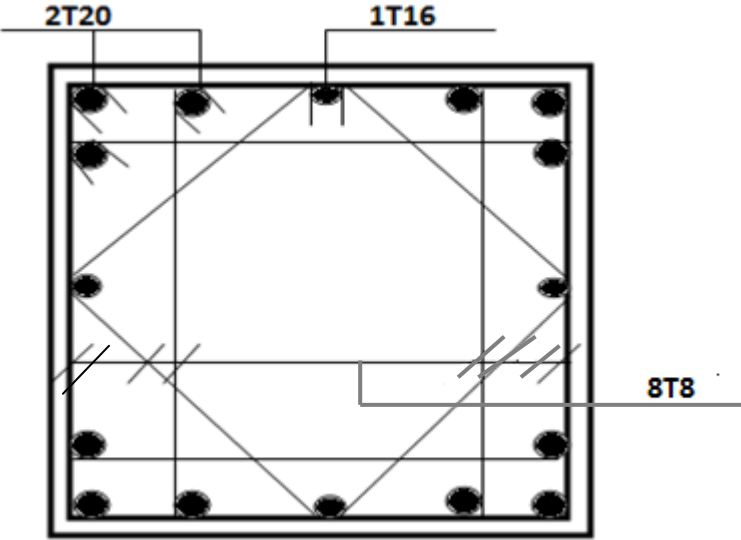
Schéma de ferrailage du poteau 60x60
